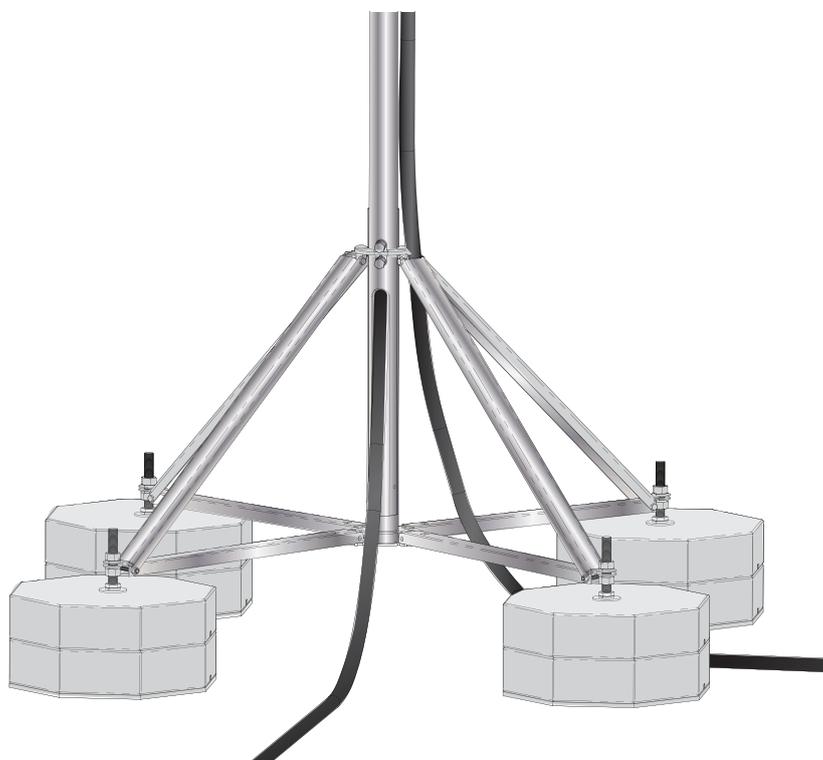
Disposición de los bloques de concreto (hormigón) en una ubicación horizontal
